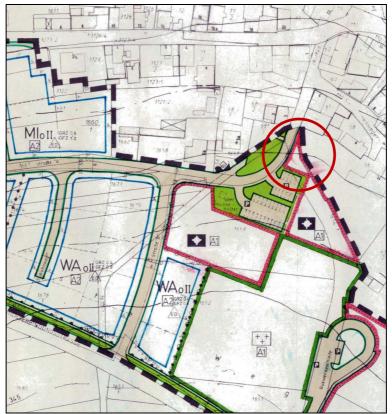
Planzeichnung Bebauungsplan "An der Zeil" (Ausschnitt) - Urplan vom 15.10.1993 Quelle: Gemeinde Eisingen
